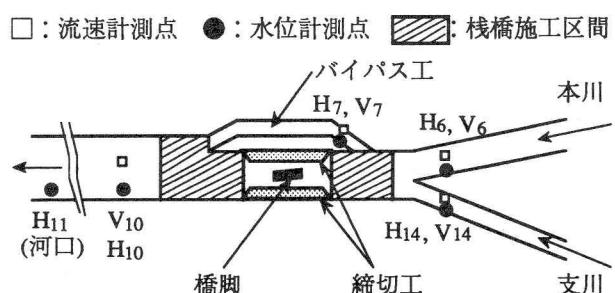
宮川橋梁架替工事の施工状況および計測位置平面図
